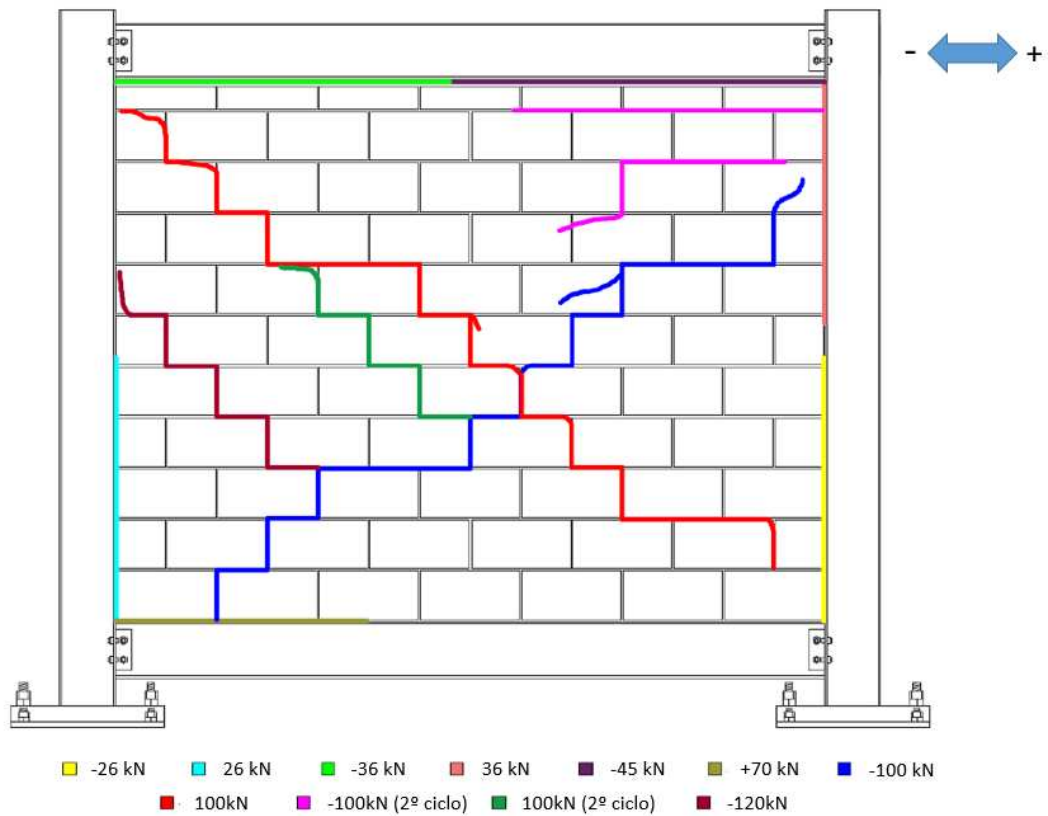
Fissuras no pórtico ensaiado PP-1-0.5/2.0.
